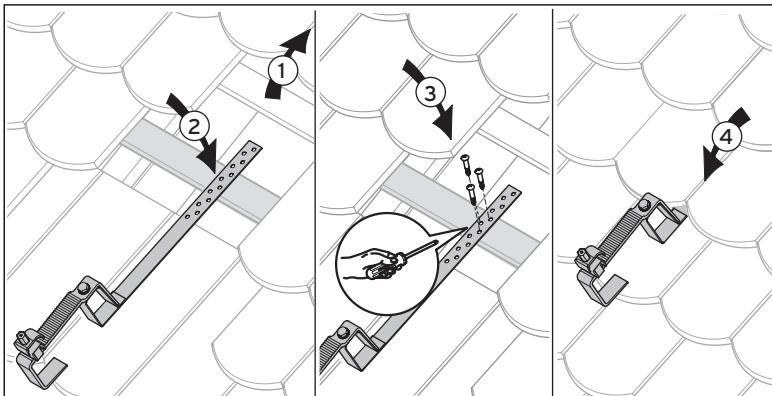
Dachanker Typ S befestigen (hier dargestellt: Befestigen an der Dachlatte)
